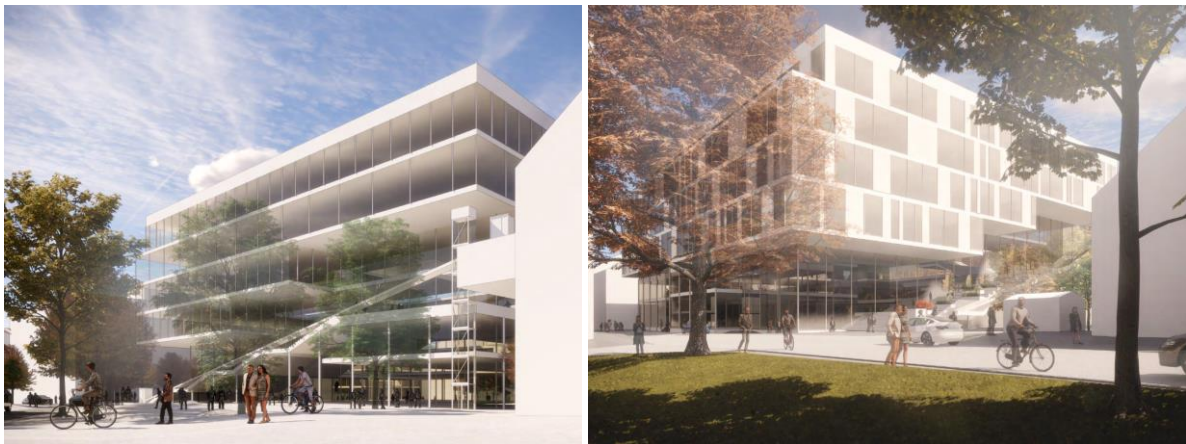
Fasadeoppriss av foreslått bygg på 6B, sett fra vest. Schøyens gate 10 til venstre i illustrasjonen.
